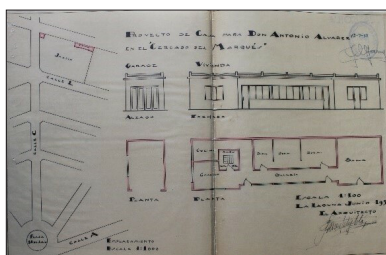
CASA ANTONIO ÁLVAREZ, 1938. Fuente: AMLL, 620-10
